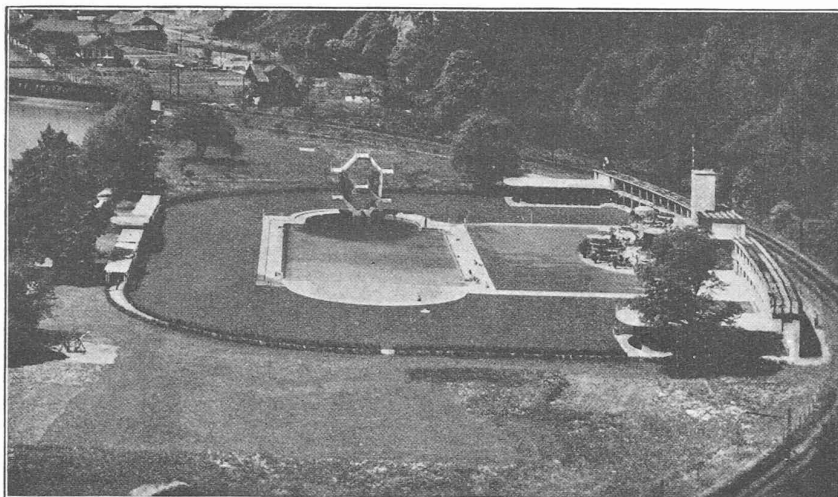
Piscine d'Interlaken. Vue d'ensemble.
